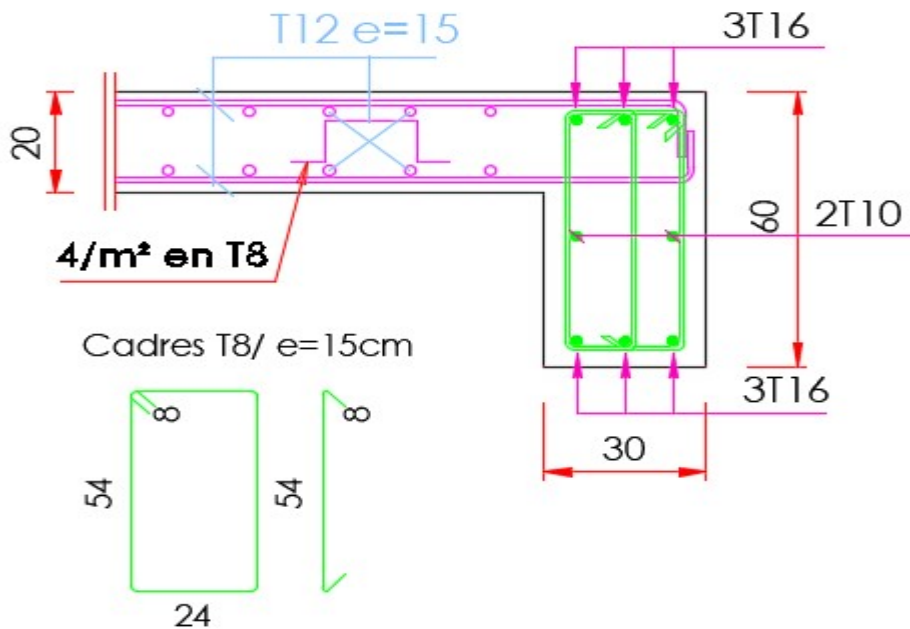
Schémas de ferrailage des poutres (30 x 60) cm²
